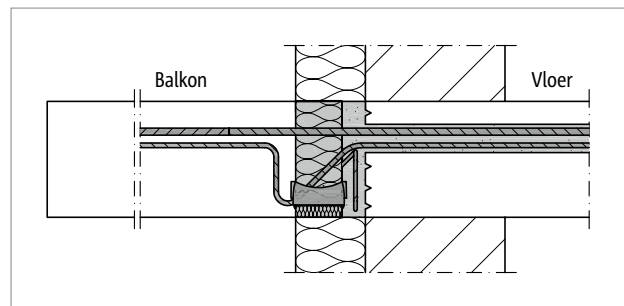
Schöck Isokorb® RT type SK: Aansluiting van een prefabbalkon op een bestaande vloerplaat, ondersteunde constructie
